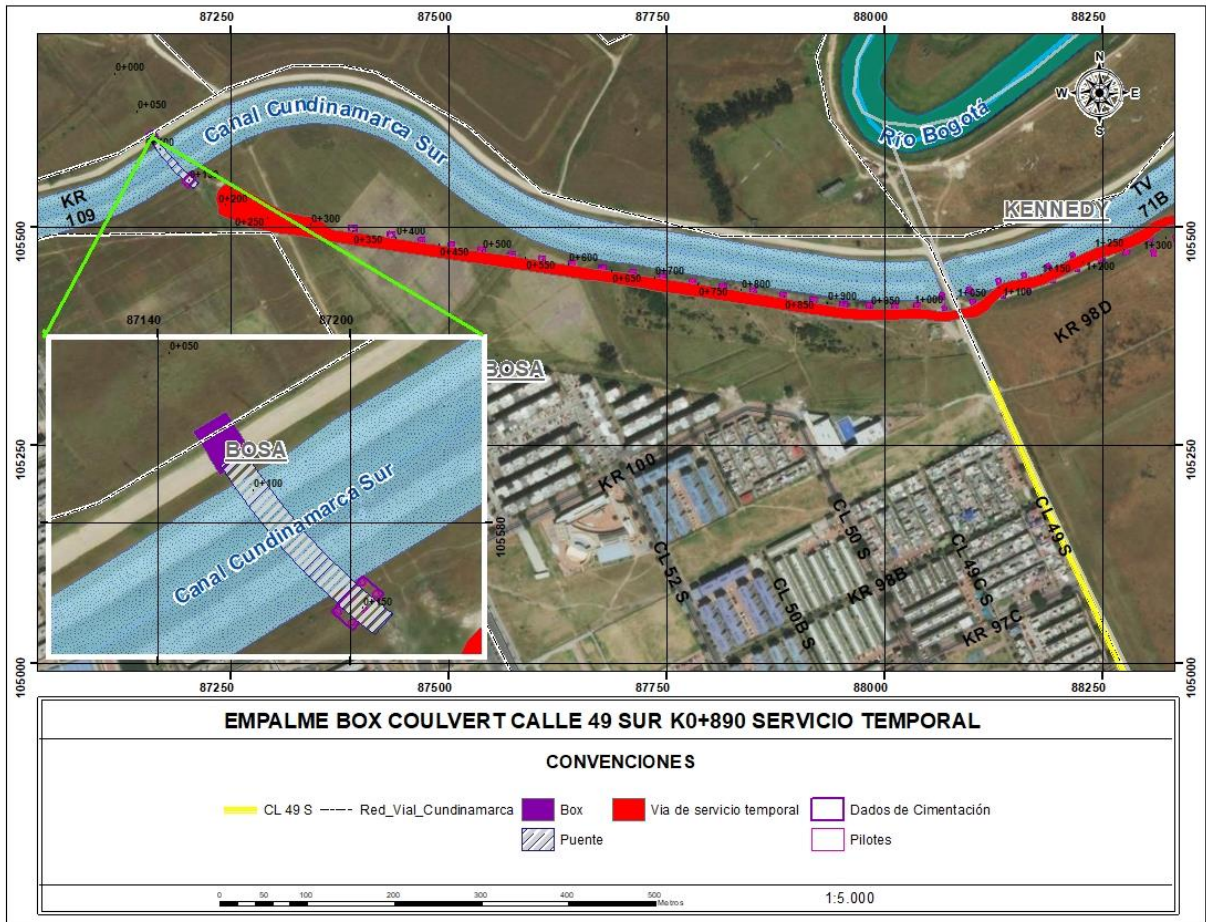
Empalme con box coulvert sobre la calle 49 sur K0+890 - vía de servicio temporal
